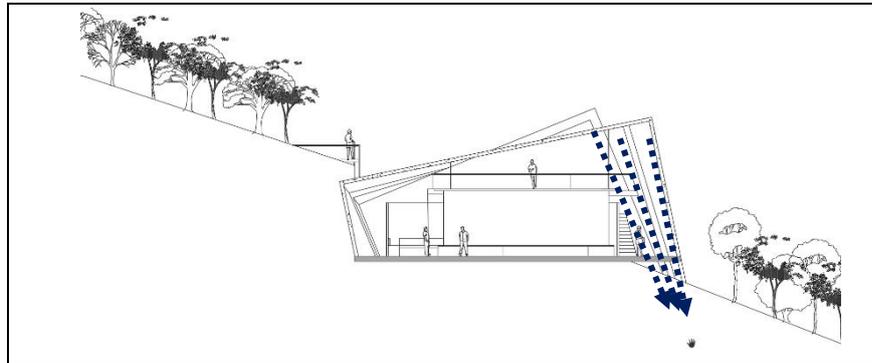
Detalle ubicación del sistema de pórticos estructurales.
